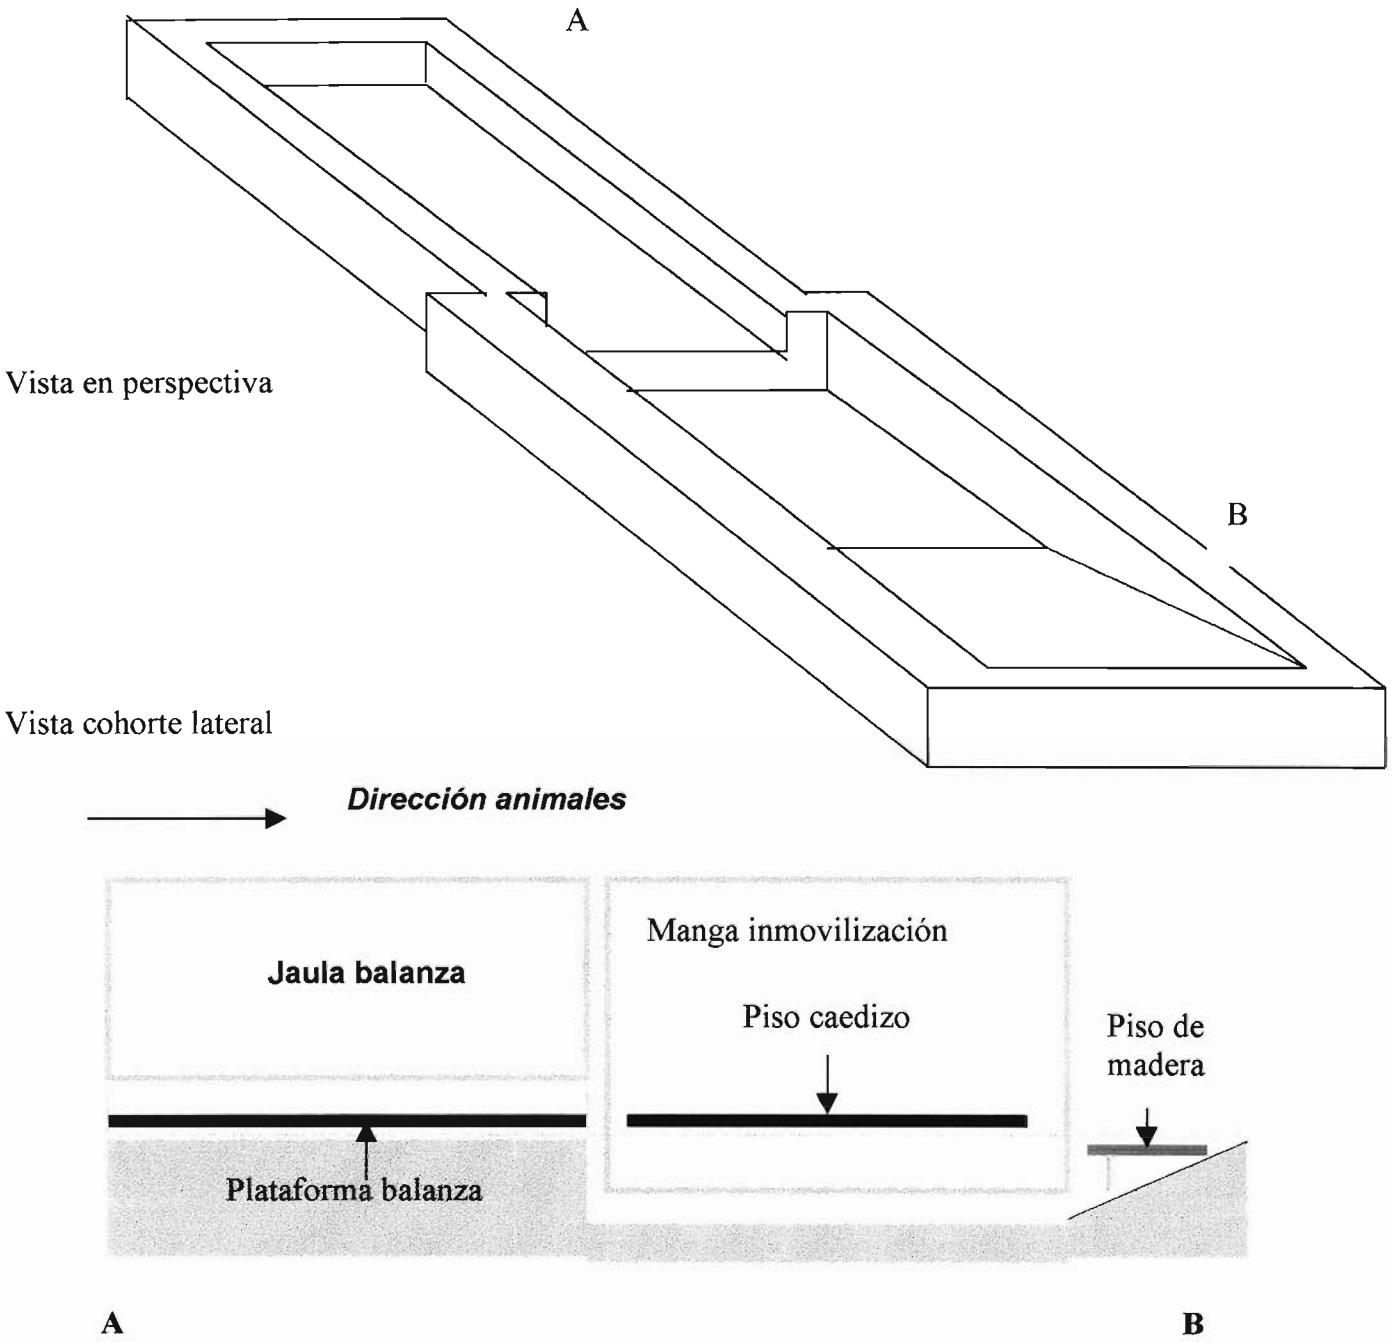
Esquema de base de concreto en construcción en el plantel Productivo para las mangas.
